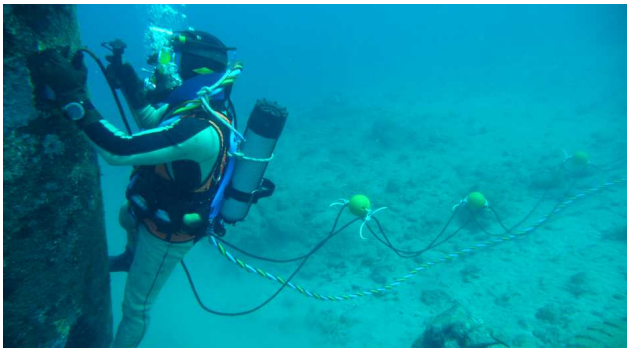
Câbles de soudage avec bouées - Wharf de Futuna
